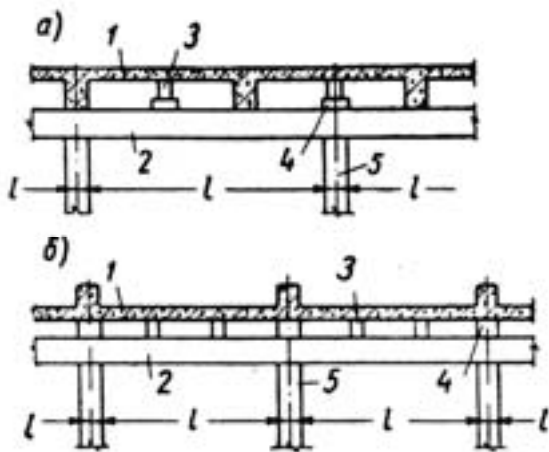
Схема підсилення ребристих плит перекриттів:
